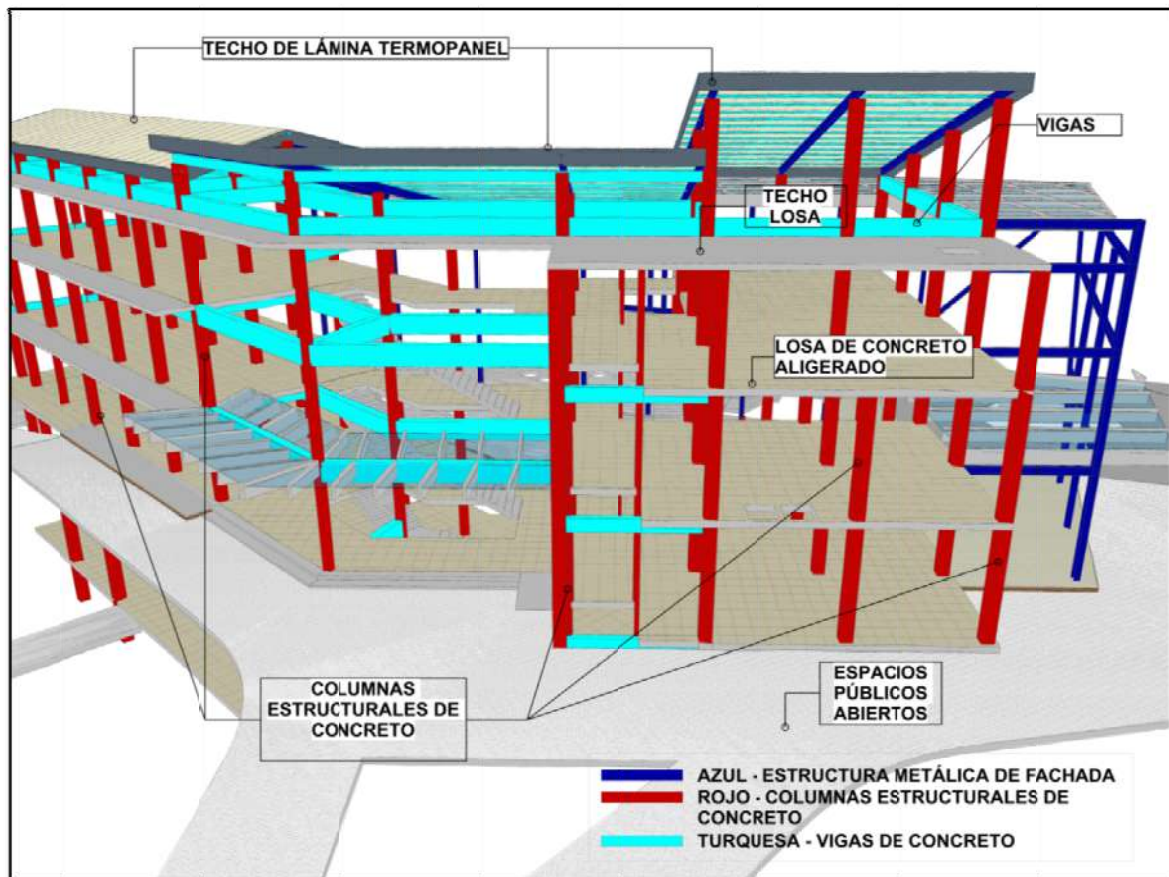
Esquema de Estructura del proyecto, columnas, vigas, losas
